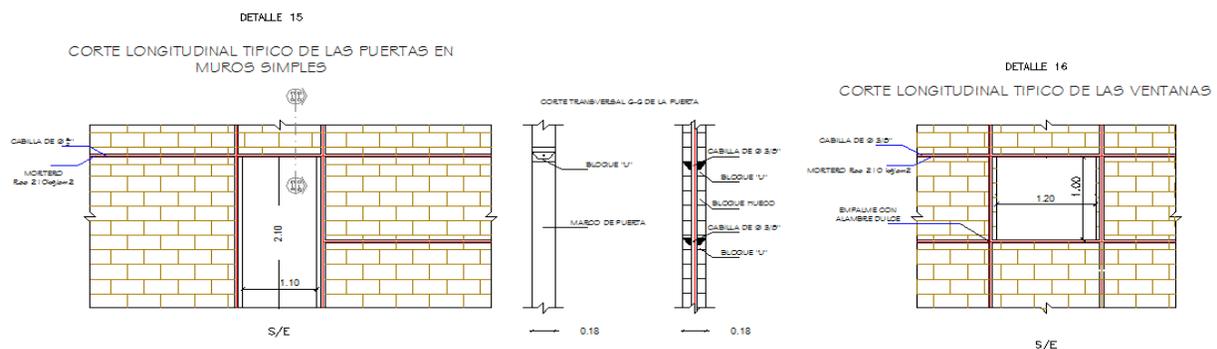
Detalles constructivos de los muros, acero vertical y horizontal.
